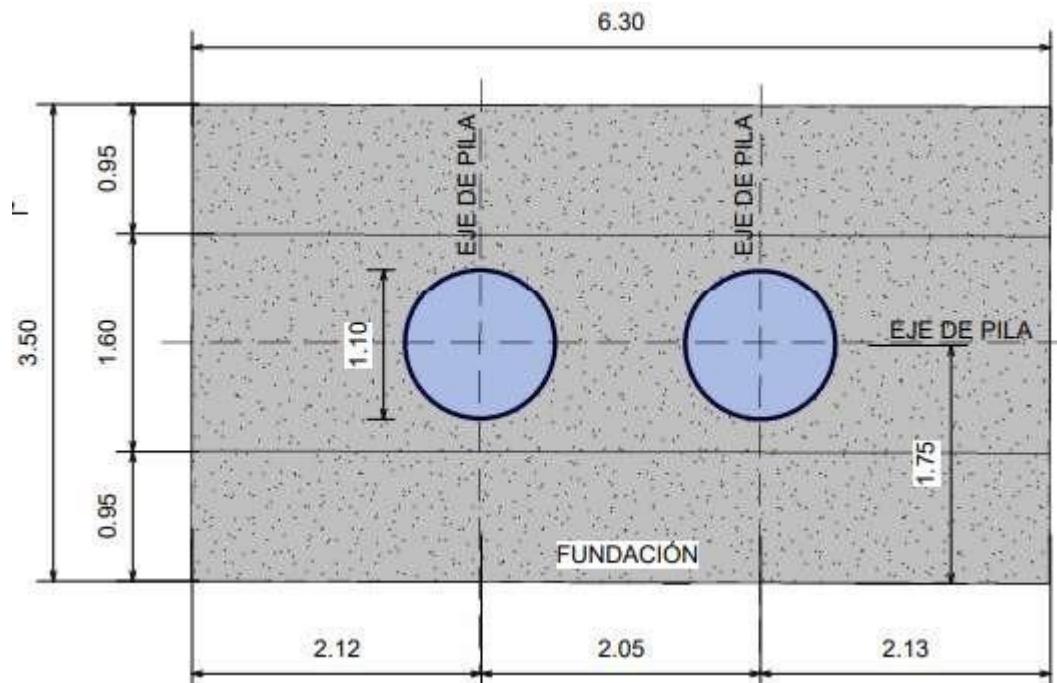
Vista en Planta de la Zapata de Fundación en el Puente Anchorena
